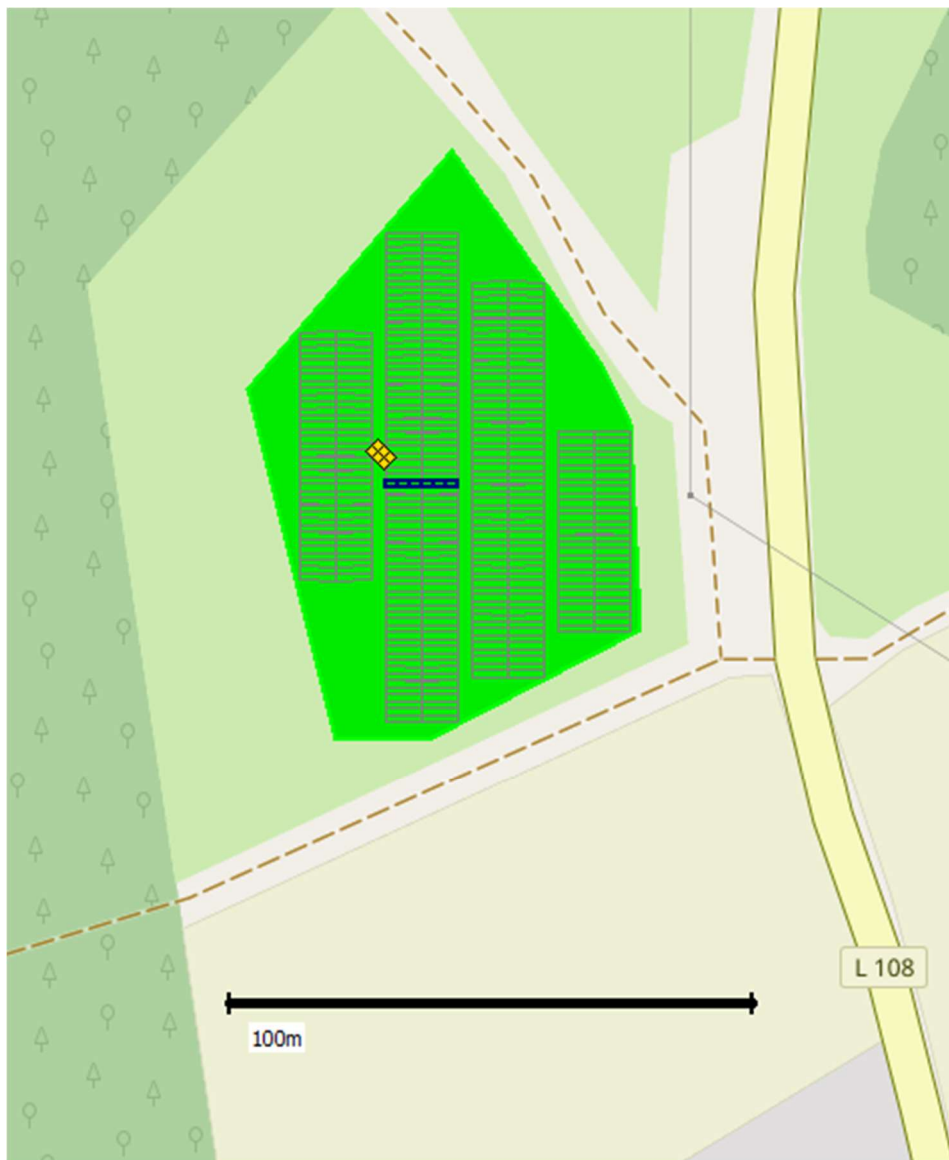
Lageplan - Teilfläche Süd mit PV-Anlage in einer Ost-West Ausrichtung mit 6er-Dach
